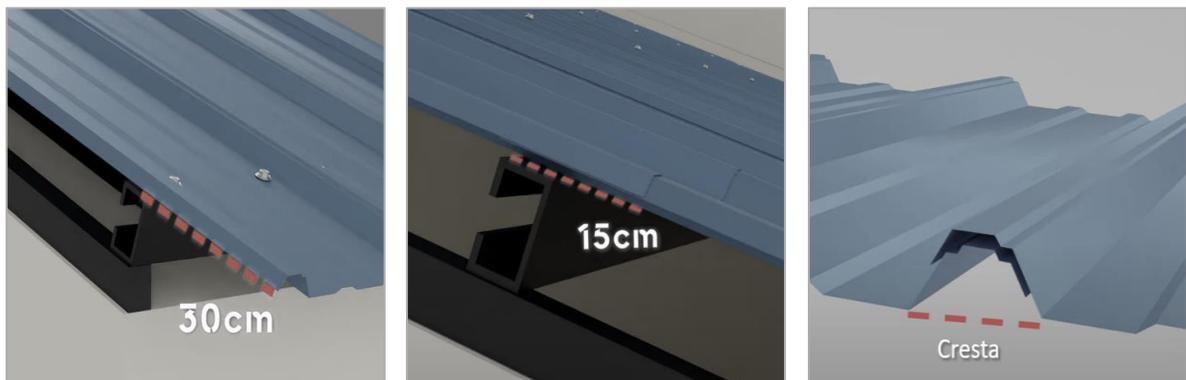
Detalles de instalación de las láminas de cubierta de techo
